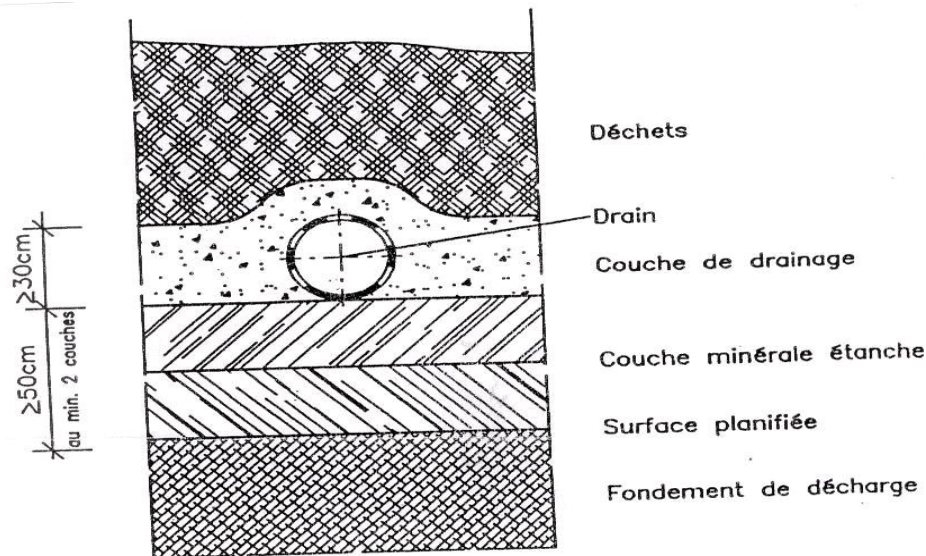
Structure d'une minérale d'étanchéité. (KITTELBERGER, 1995) [3].
